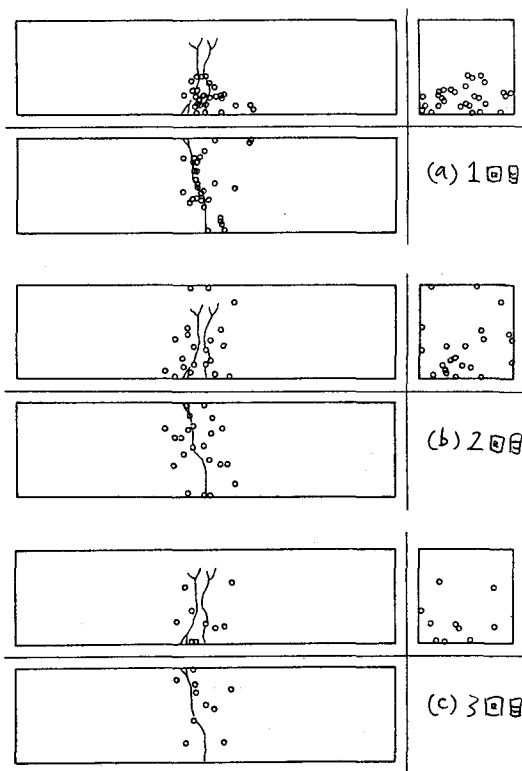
鋼繊維補強コンクリート曲げ供試体の破壊位置
